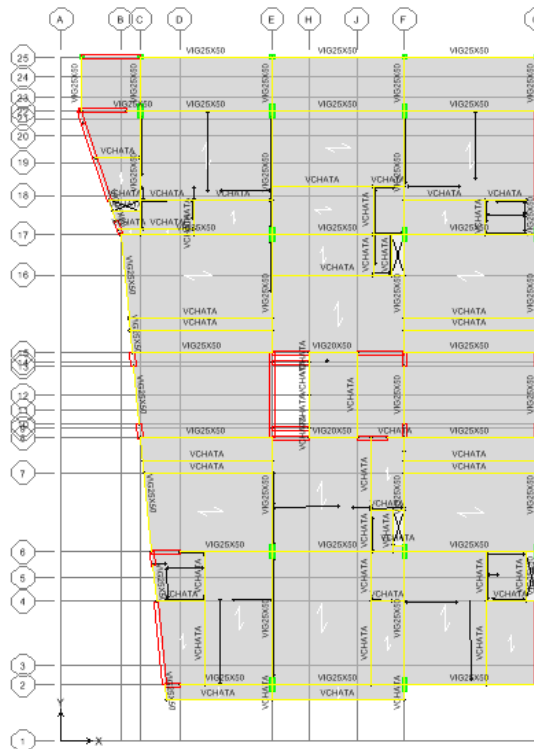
g. Distribución en planta de vigas, columnas, placas y losas para el análisis.
